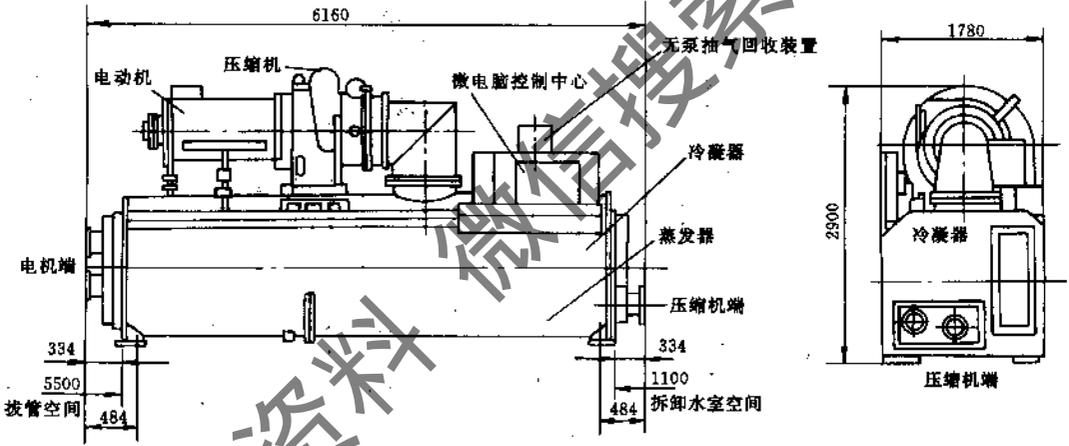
LSBLXR 系列 2450/2800 型离心式冷水机组外形尺寸图
